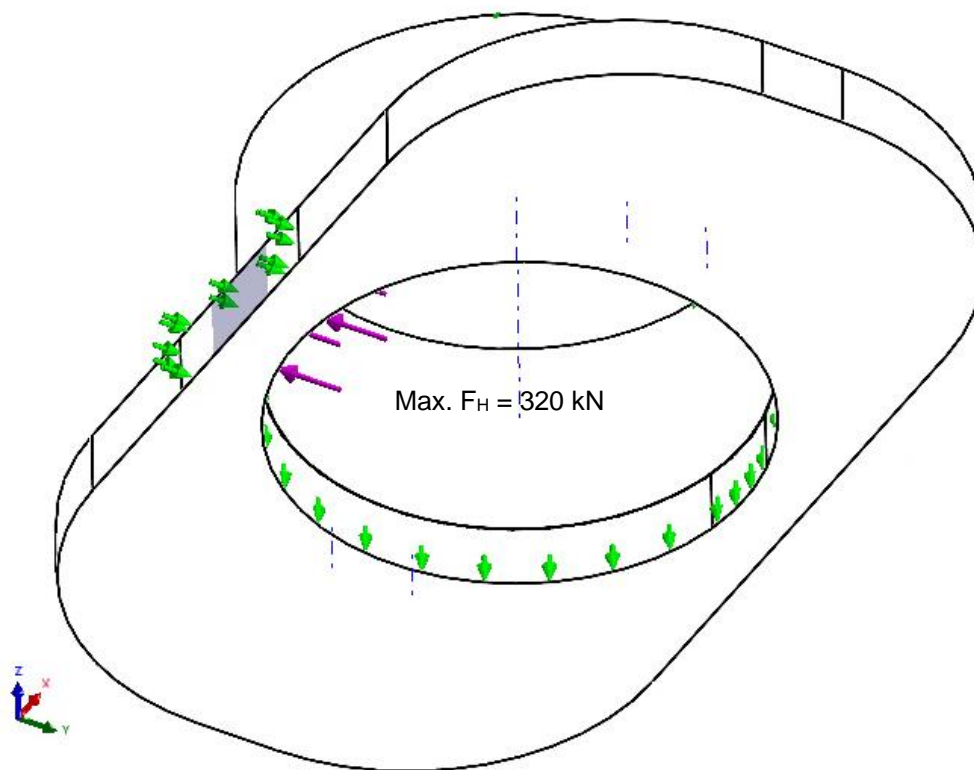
Schlitten-Platte für alle Brücken außer Brücke B4 – Übersicht, Lagerung, Lasten
